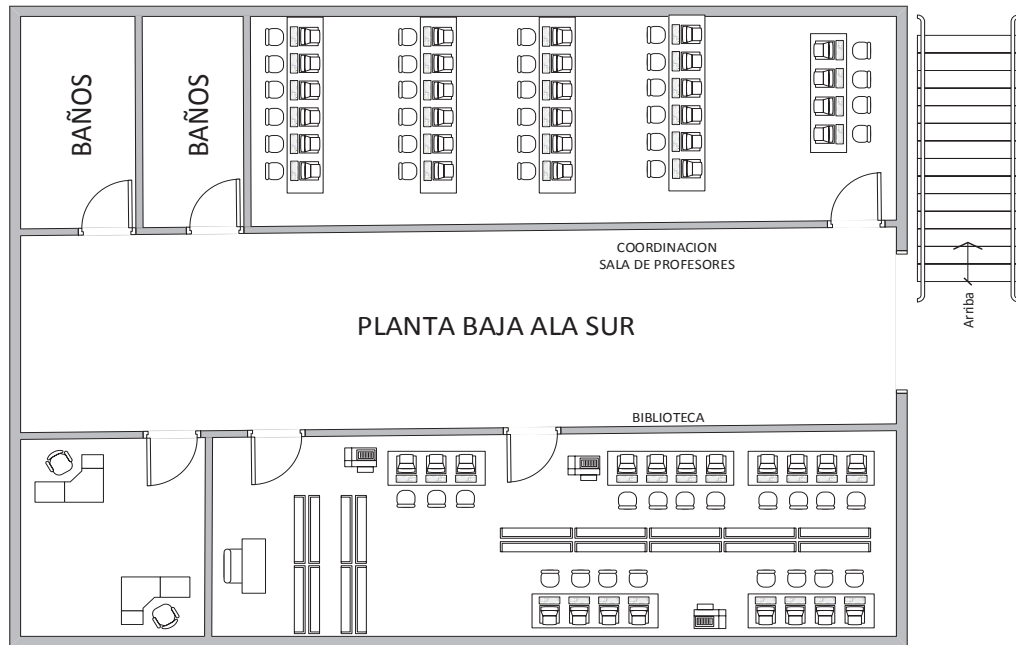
Distribución de las áreas Planta Baja ala sur
